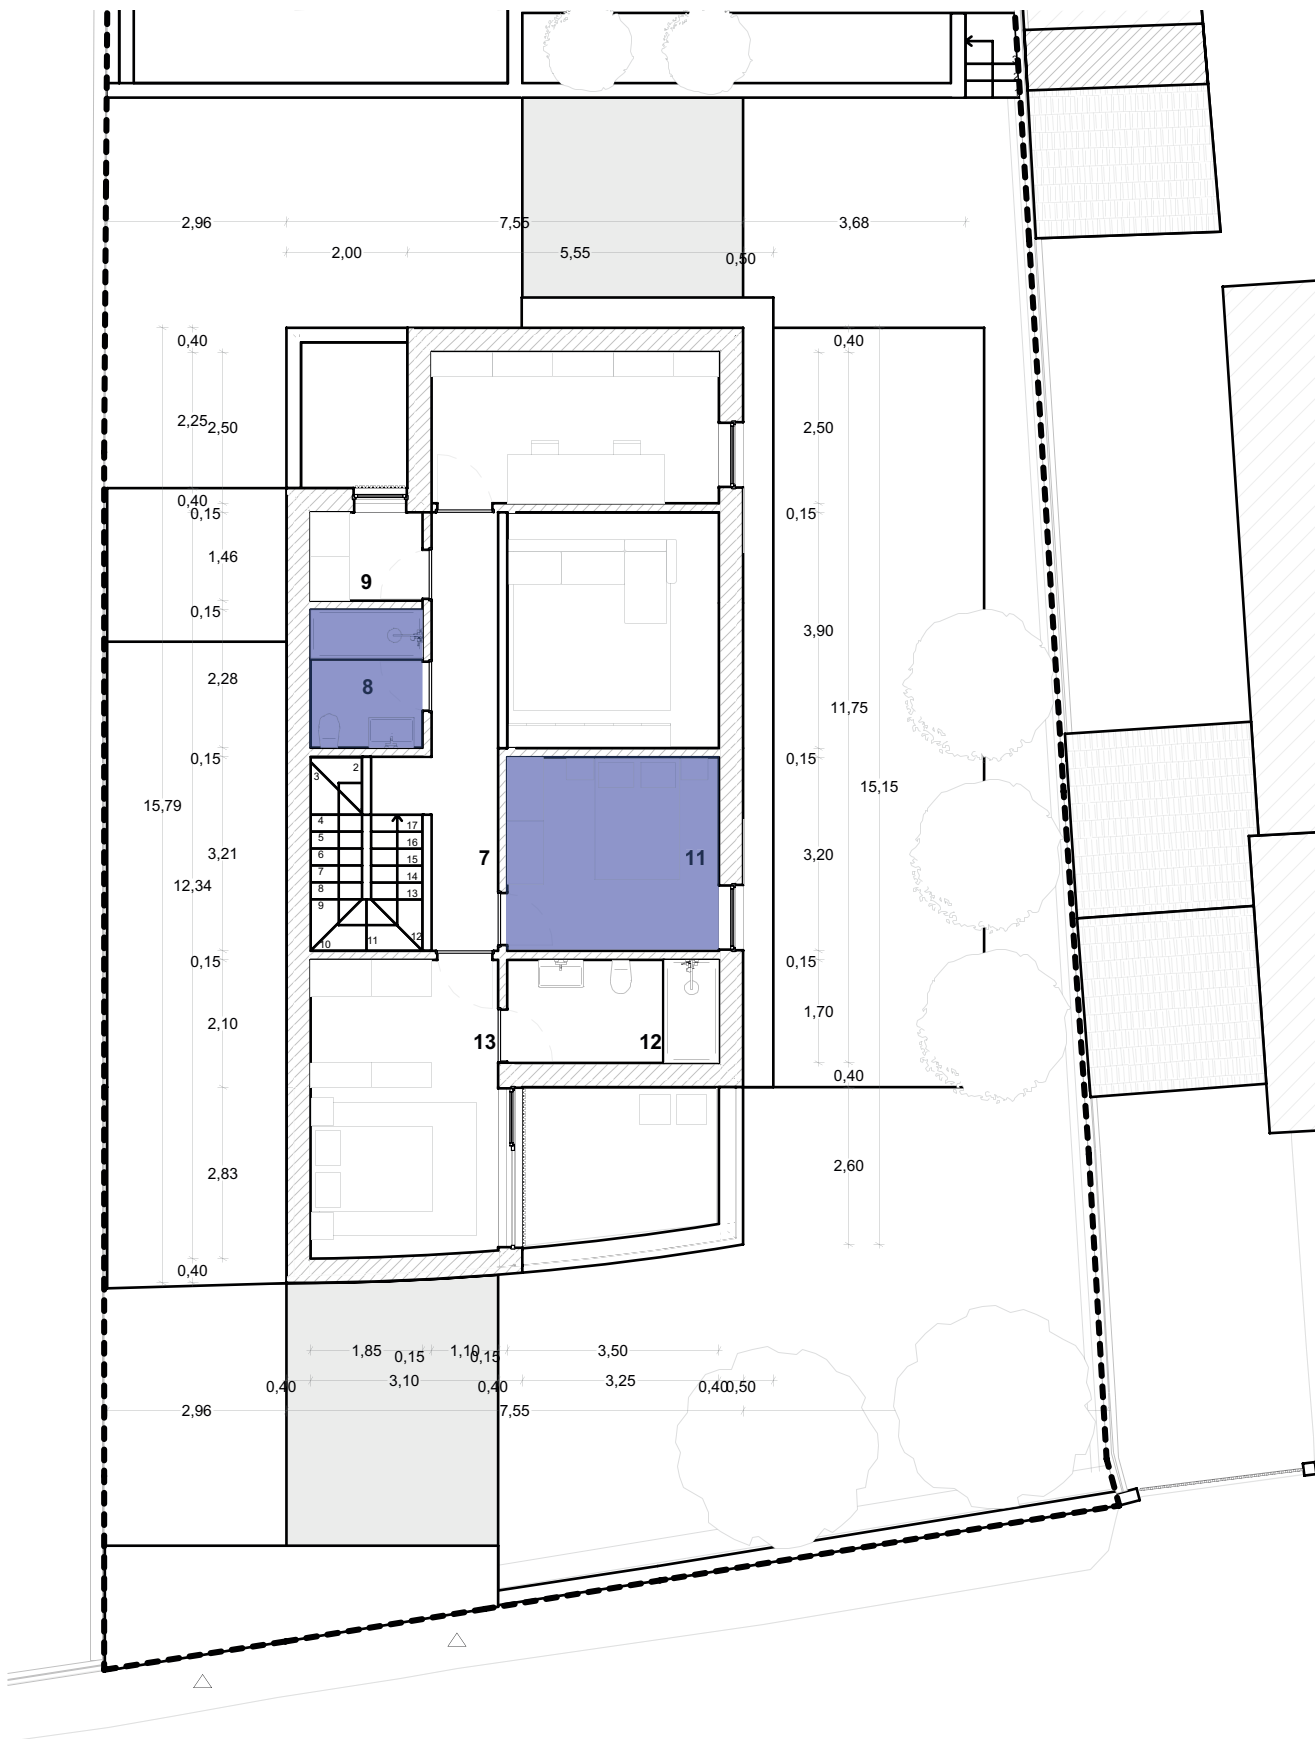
Planta piso 1, identificação das divisões trabalhadas.
